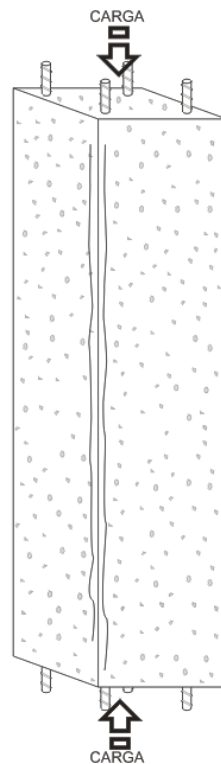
Fisuras por cerramiento de estribos en la misma barra de acero principal.
